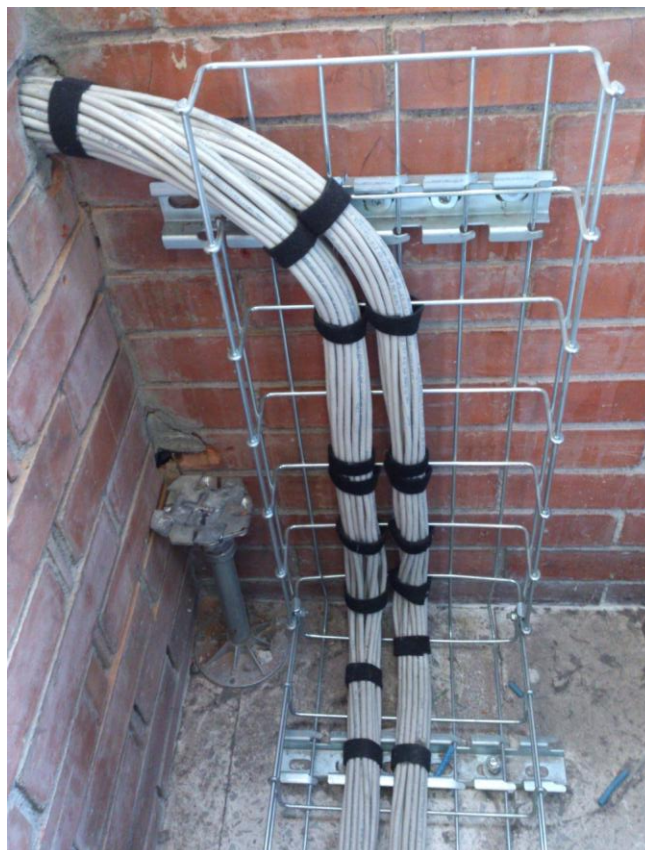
Instalación de escalerilla en Site de CTI
